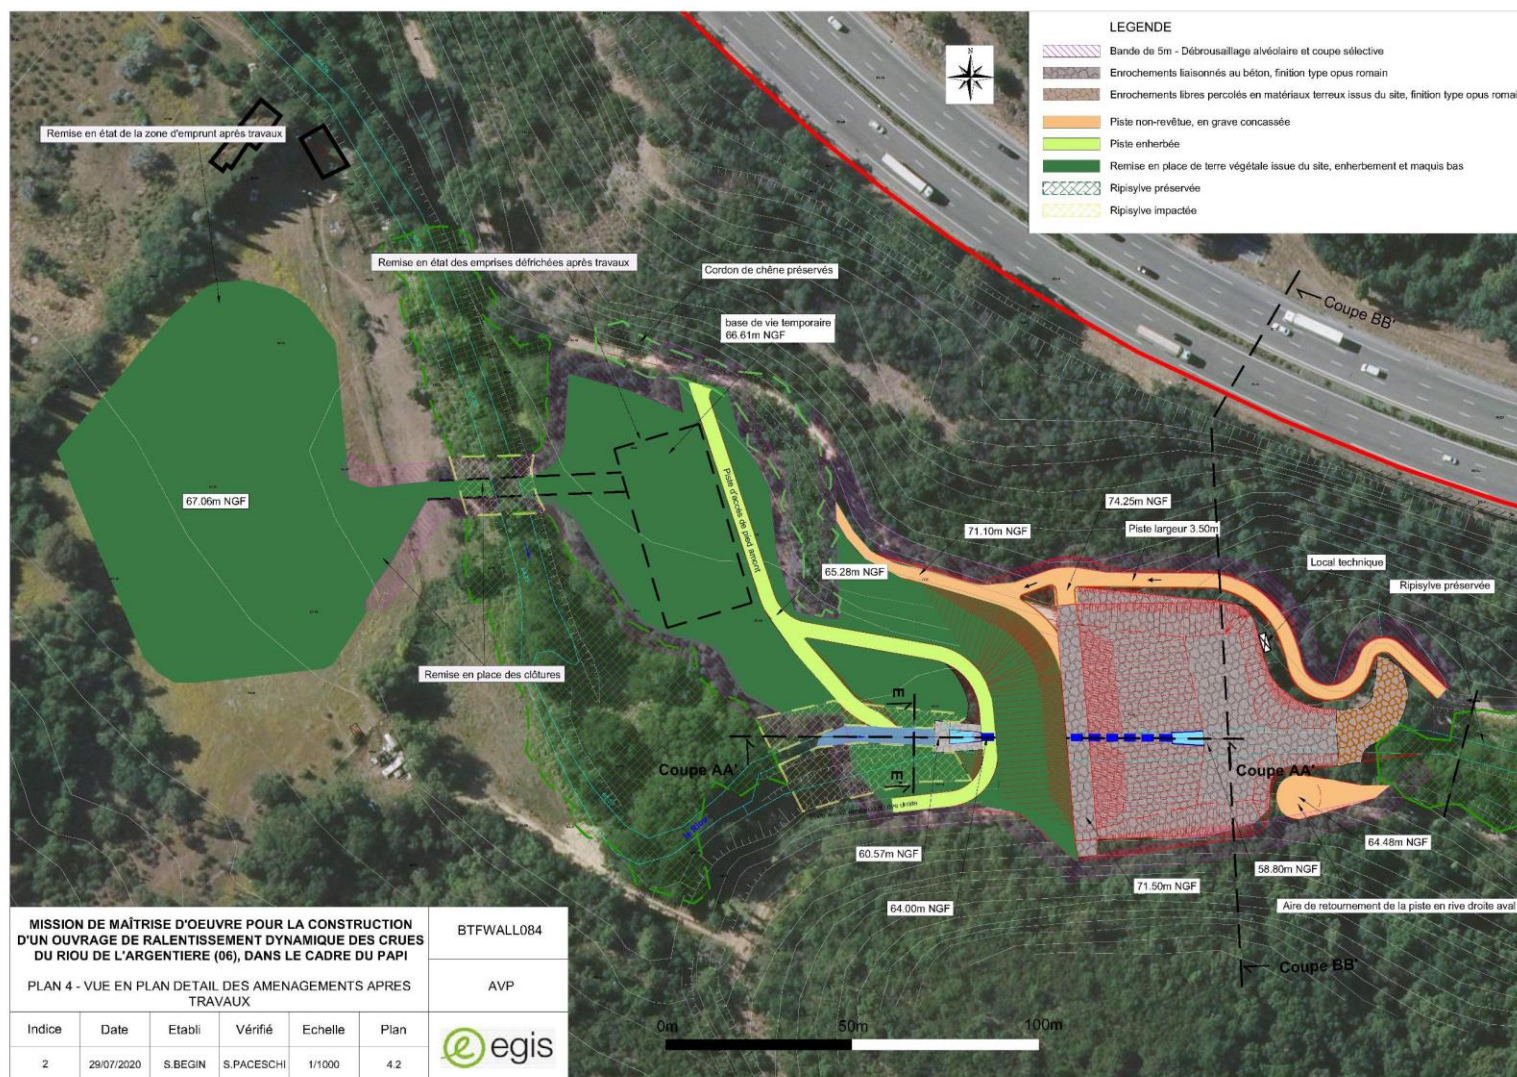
Plan d'aménagement de l'ouvrage et de ses abords
